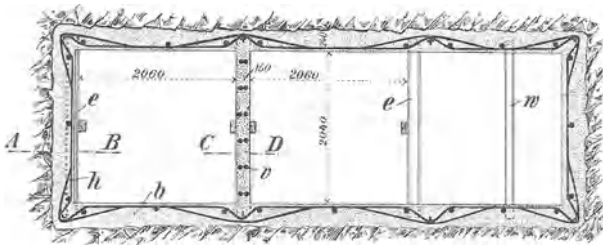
Eisenbetonausbau eines rechteckigen Schachtes als Ersatz für Holzausbau.
